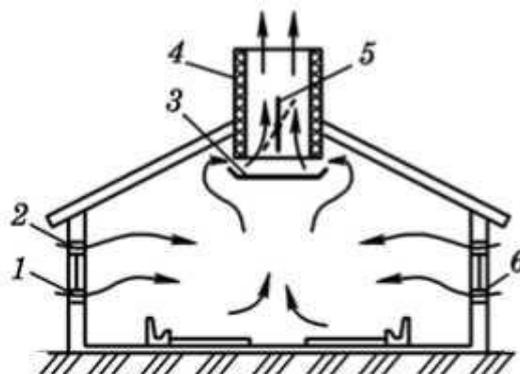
Схема вытяжной вентиляции животноводческого помещения:
